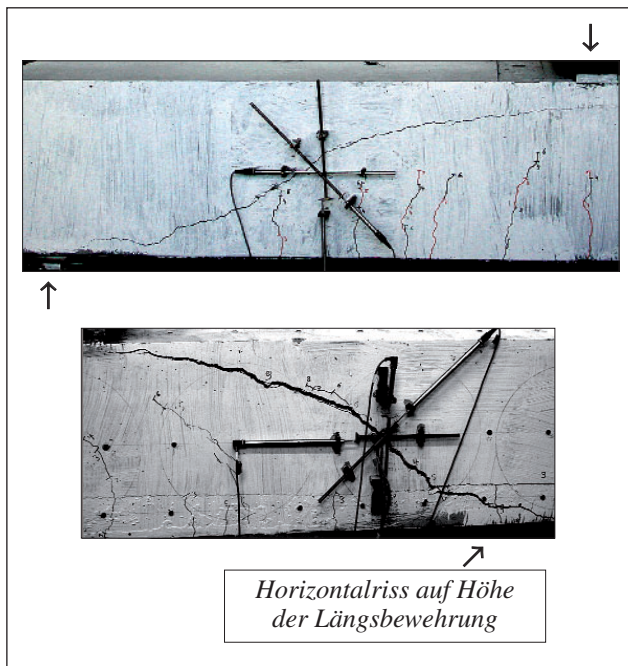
Schubriss, Massivdecke 450-V1(o.), Hohlkörperdecke 450-V3 (u.)
